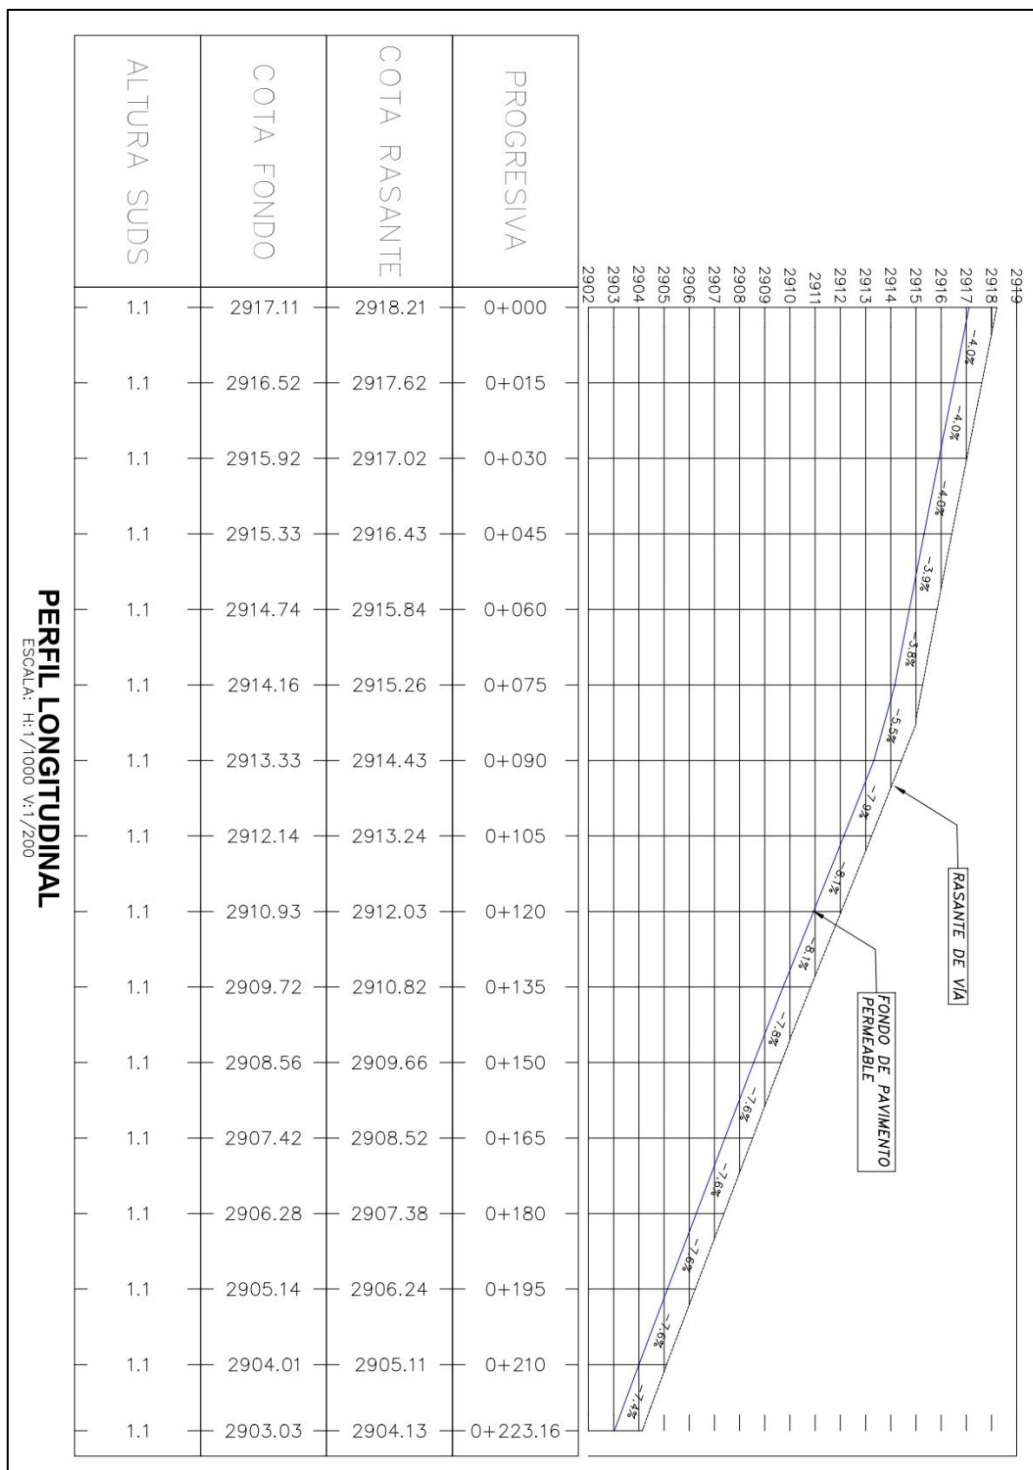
Perfil longitudinal del pavimento permeable (PAV06)
